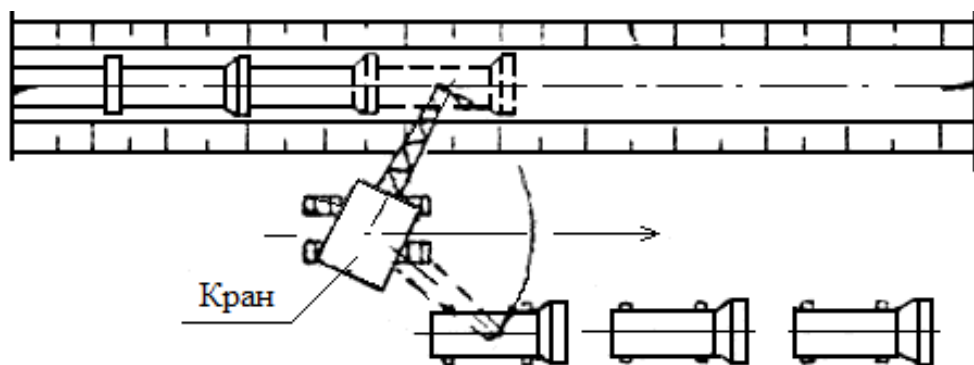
Раскладка раструбных труб вдоль траншеи «в нитку» с укладкой краном
